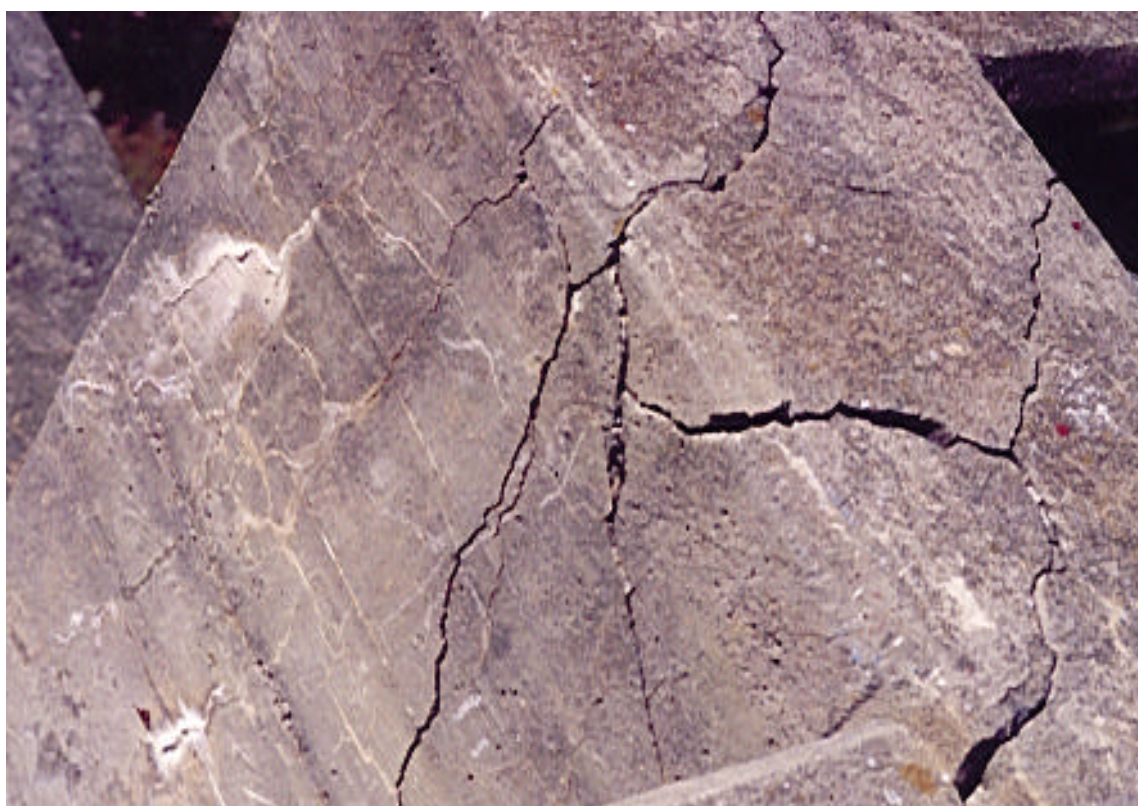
Fissuras poligonais na superfície – Obra nos Estados Unidos.
